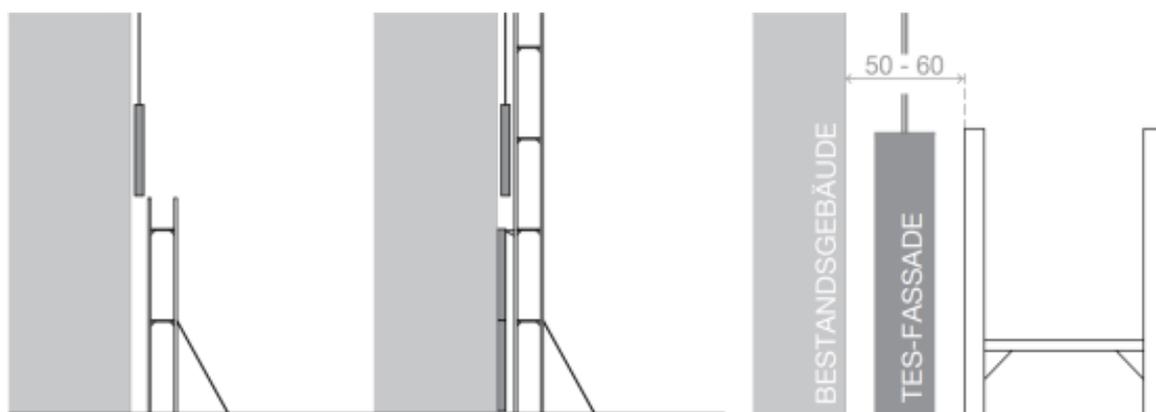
Montage der TES Elemente – das Gerüst wächst mit dem Baufortschritt mit
